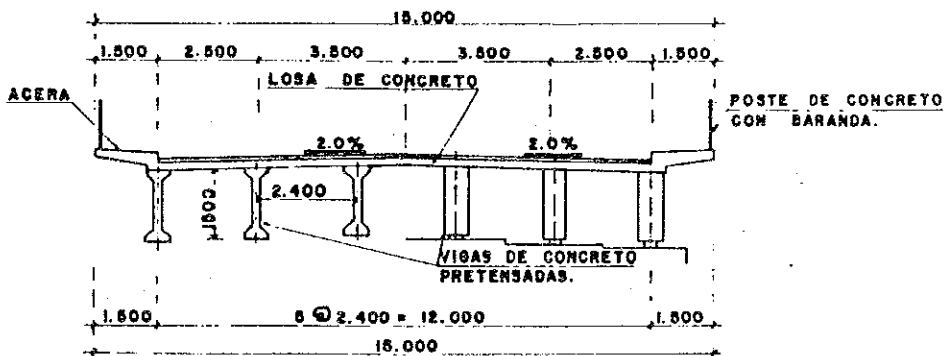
Puente El Arroyo N°1, Viga de Concreto Postensado
